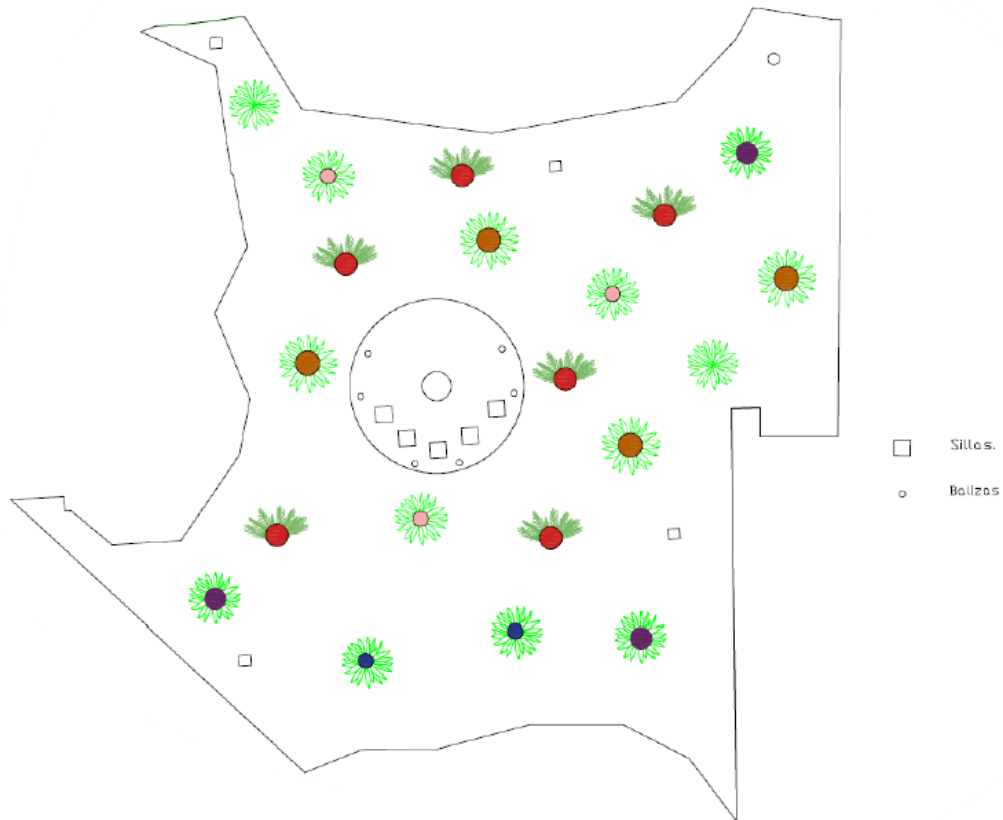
Plano de detalle parcela 1. Fuente: propia.
